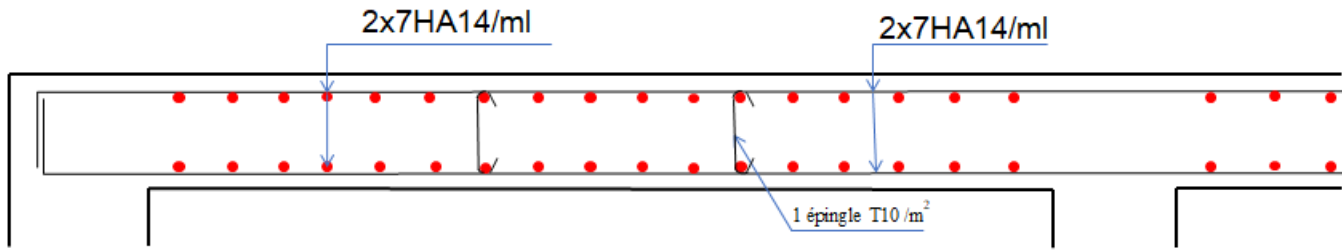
Schéma de ferrailage du dalles pleines
